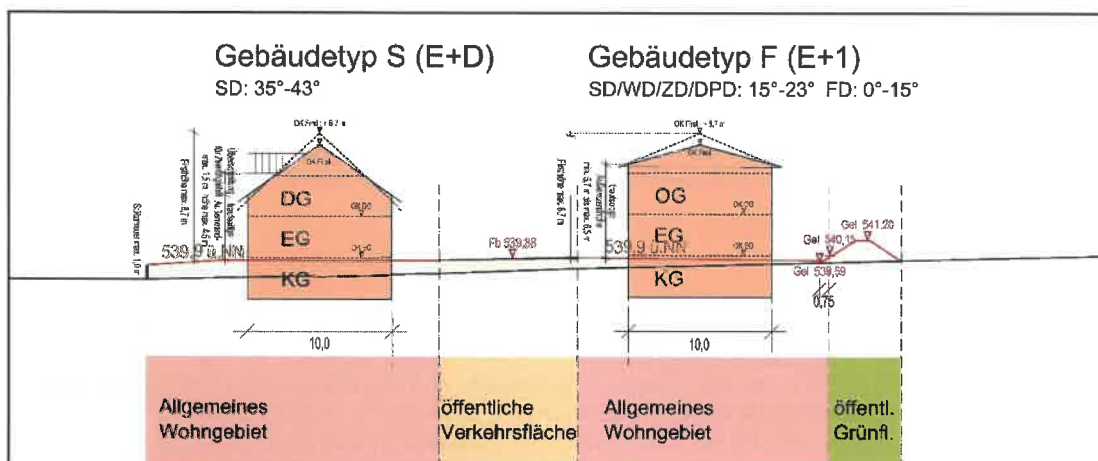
Systemschnitte Gebäudetyp S (spitzgiebliches Dach - „E+D“) und Gebäudetyp F (flachgeneigtes Dach „E+1“) sowie Gelände- und Höhenveränderungen
